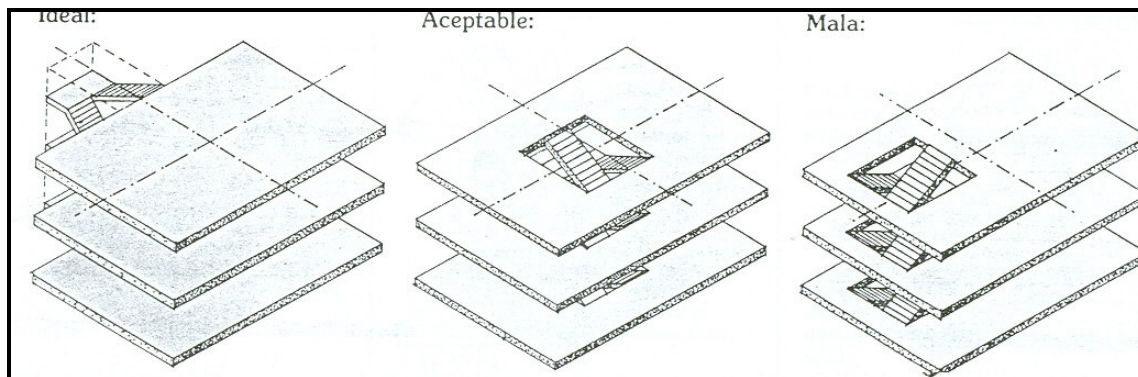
Aberturas nas lajes (VARGAS, 1987).
